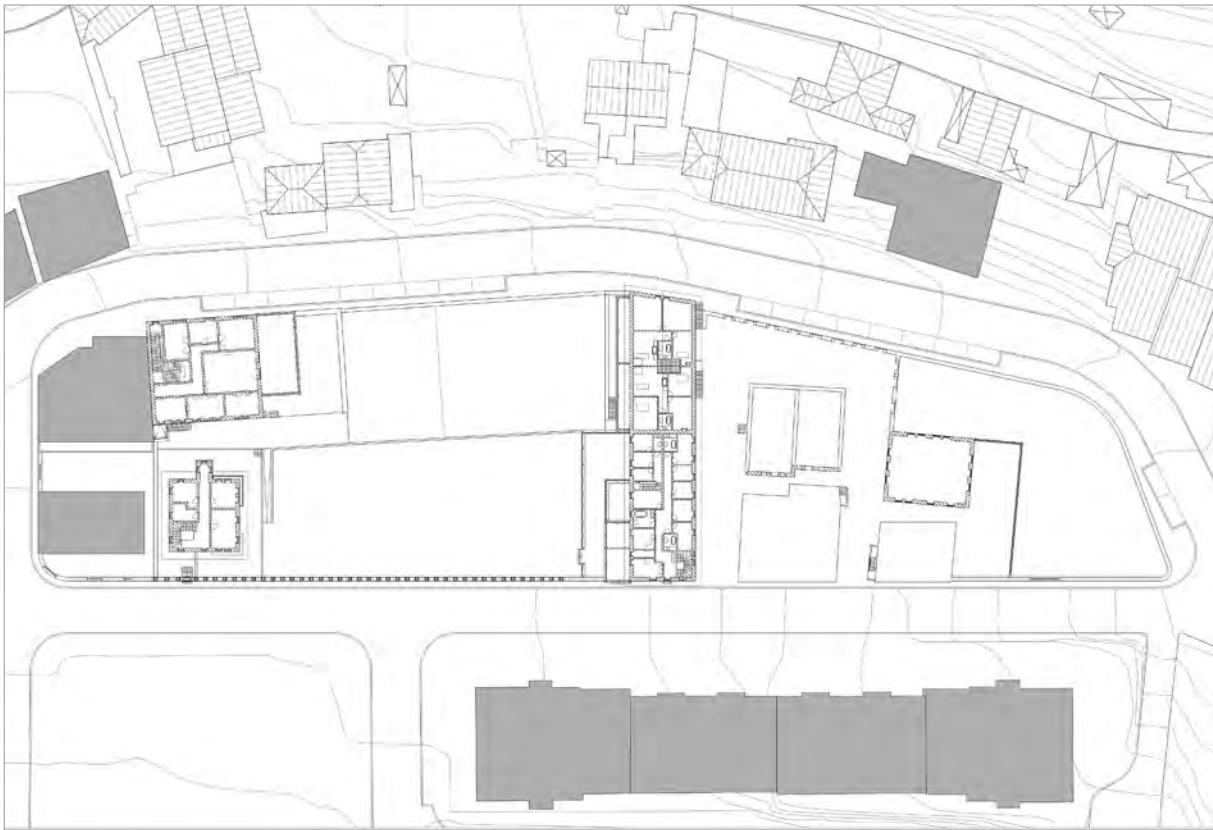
Planta de levantamento do Bairro Ricardo Mota, à cota 685.2.
